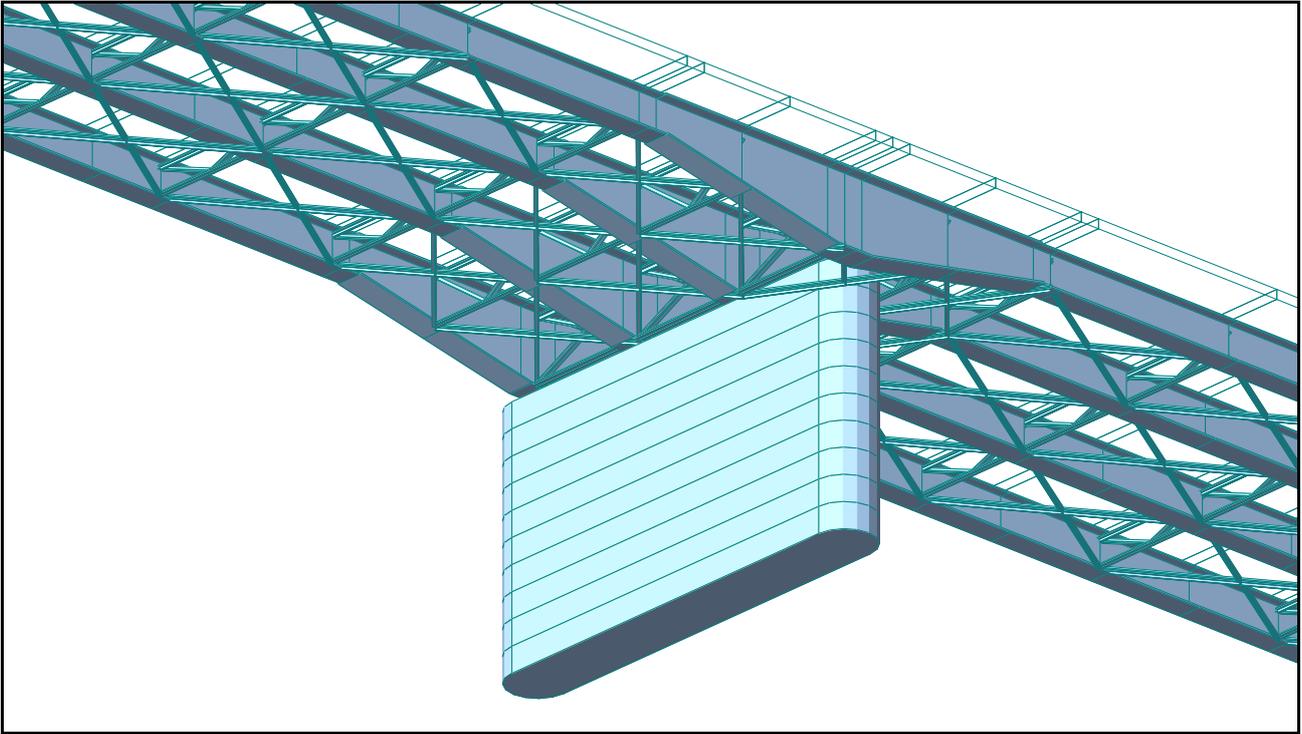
SCHEMA DI CALCOLO – PARTICOLARE SU PILA
